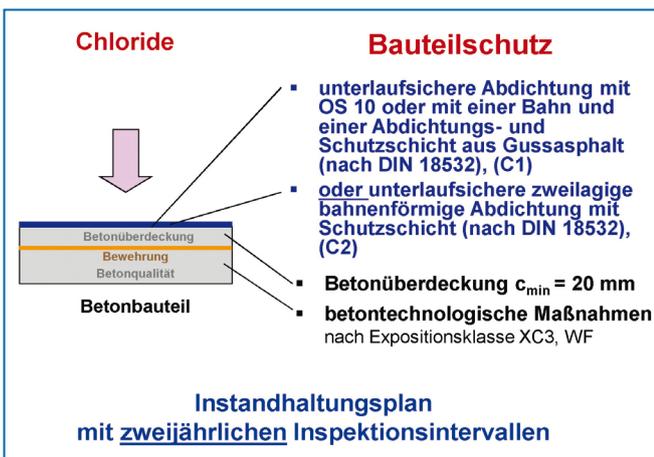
Planungsvariante C: Flächige rissüberbrückende und unterlaufsichere Abdichtung nach DIN 18532
